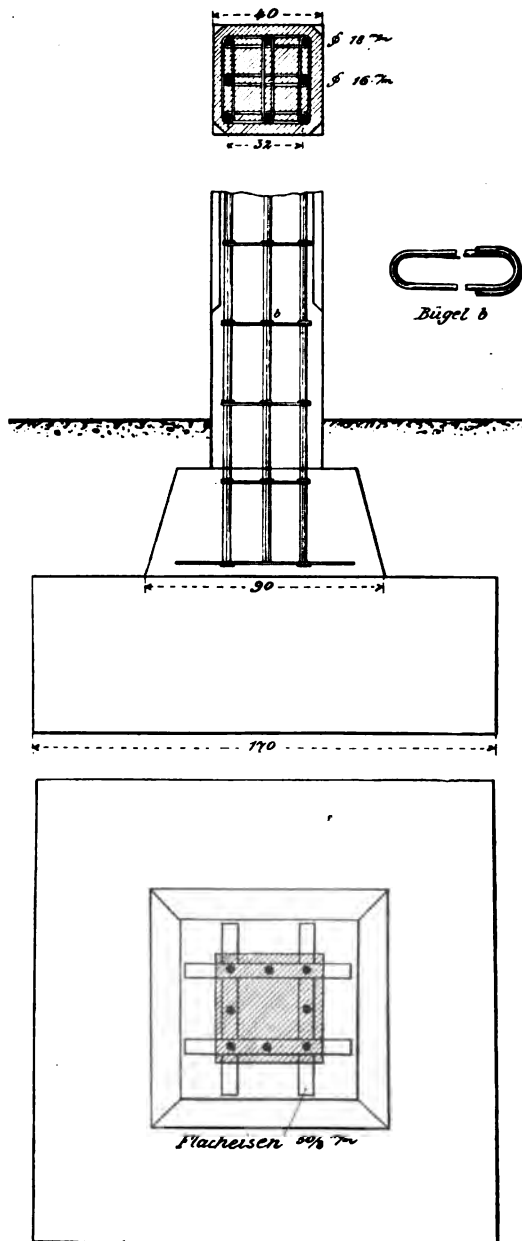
Fuß und Querschnitt einer Eisenbetonsäule.
